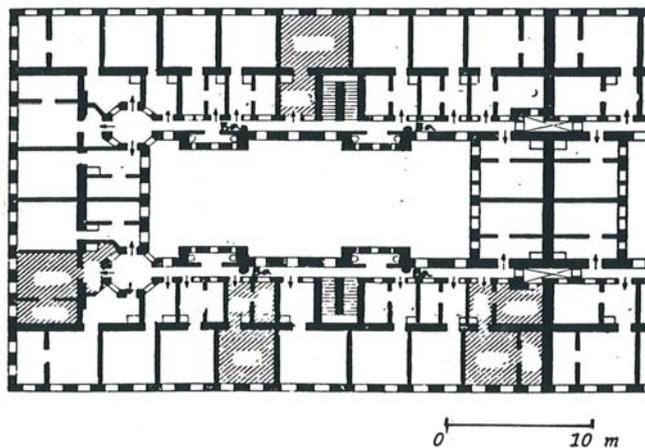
Grundriss Rinnböckhof, Wien
